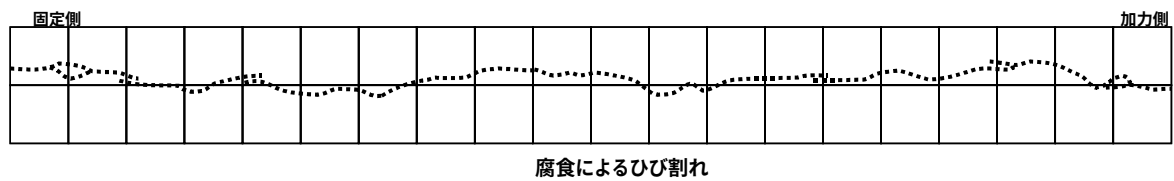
ひび割れ開口に対する拘束筋を有する試験体のひび割れ発生状況
